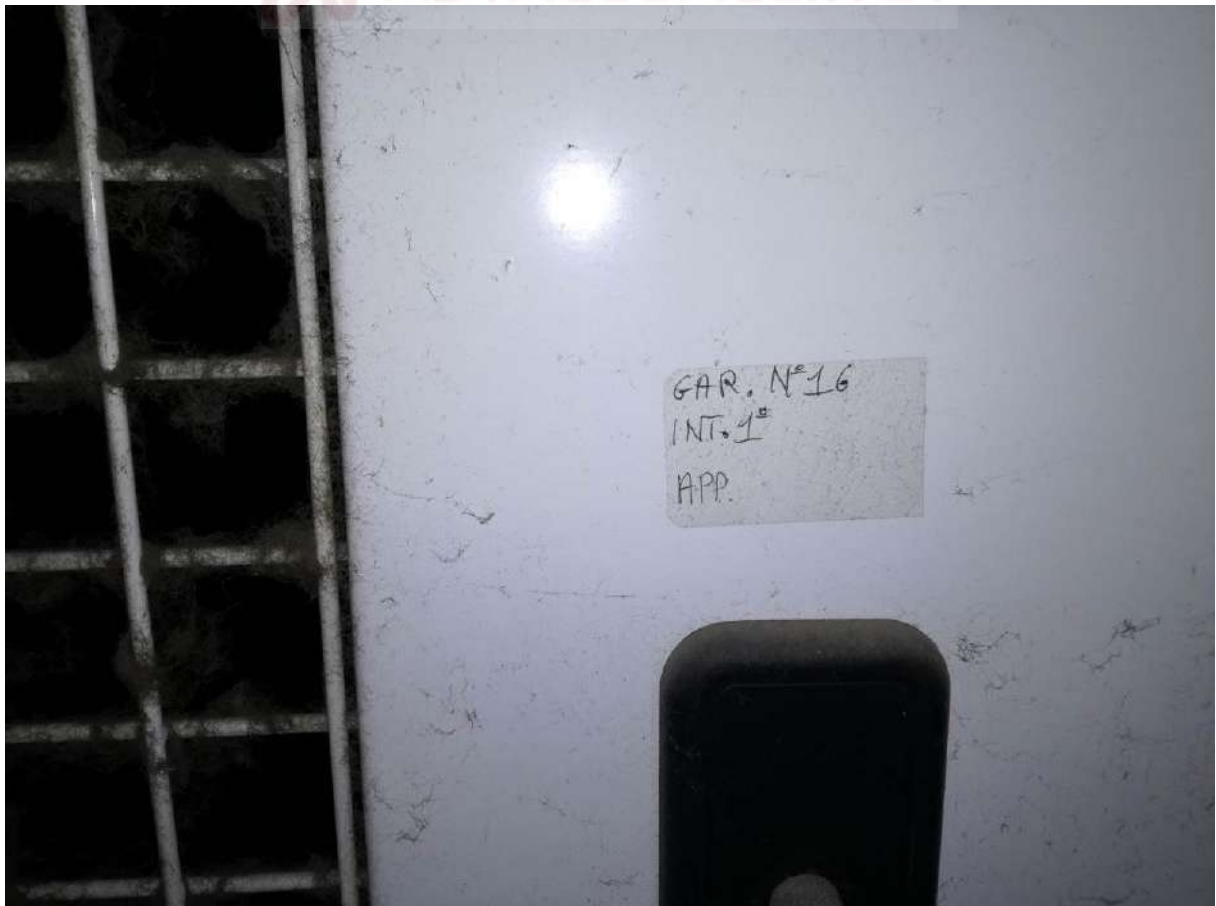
GARAGE n.16 P.1° INTERRATO – SUB55
